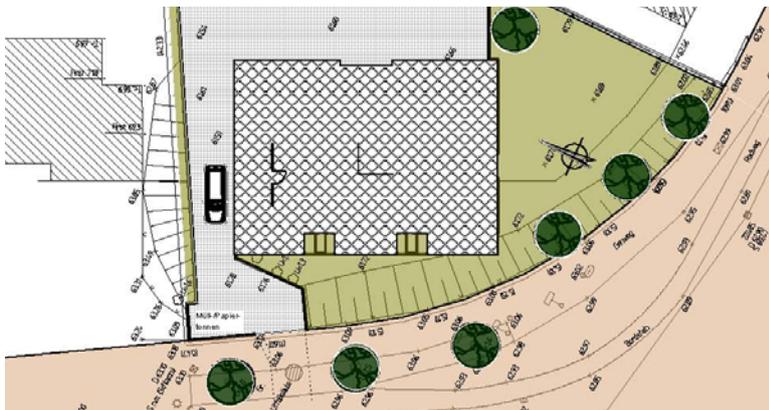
Auszug Lageplan (unmaßstäblich)
